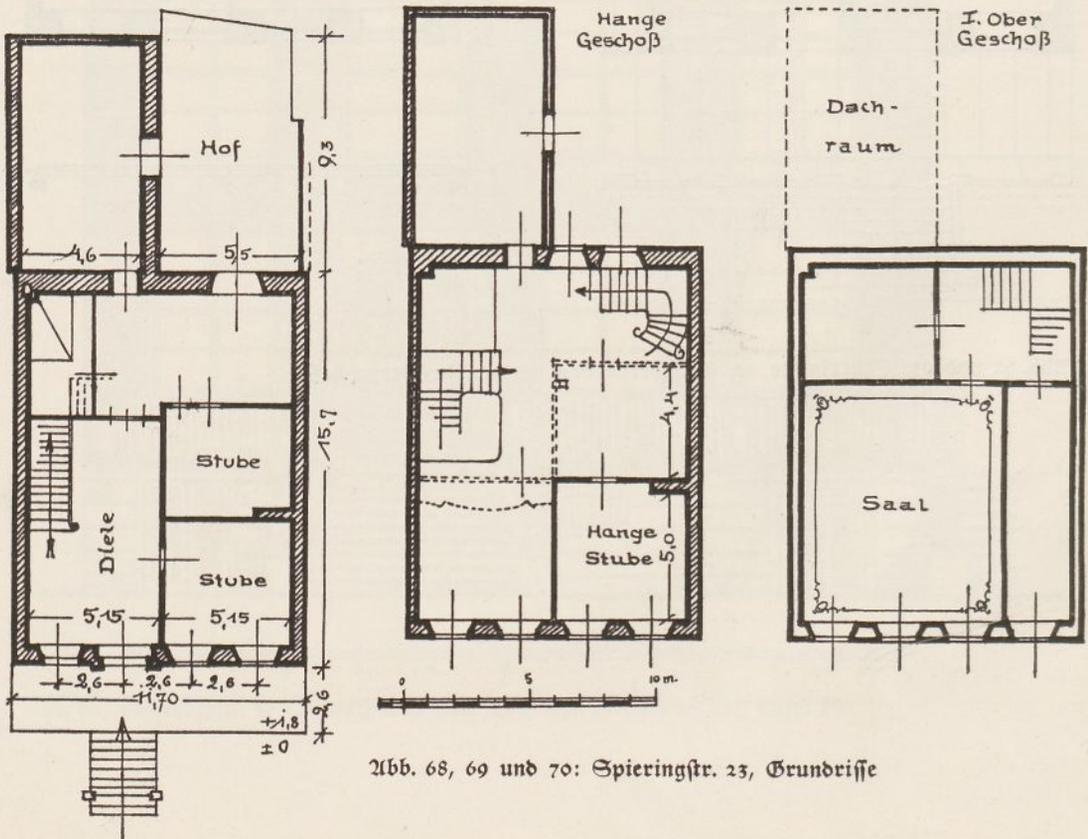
, 69 und 70: Spieringstr. 23, Grundrisse
